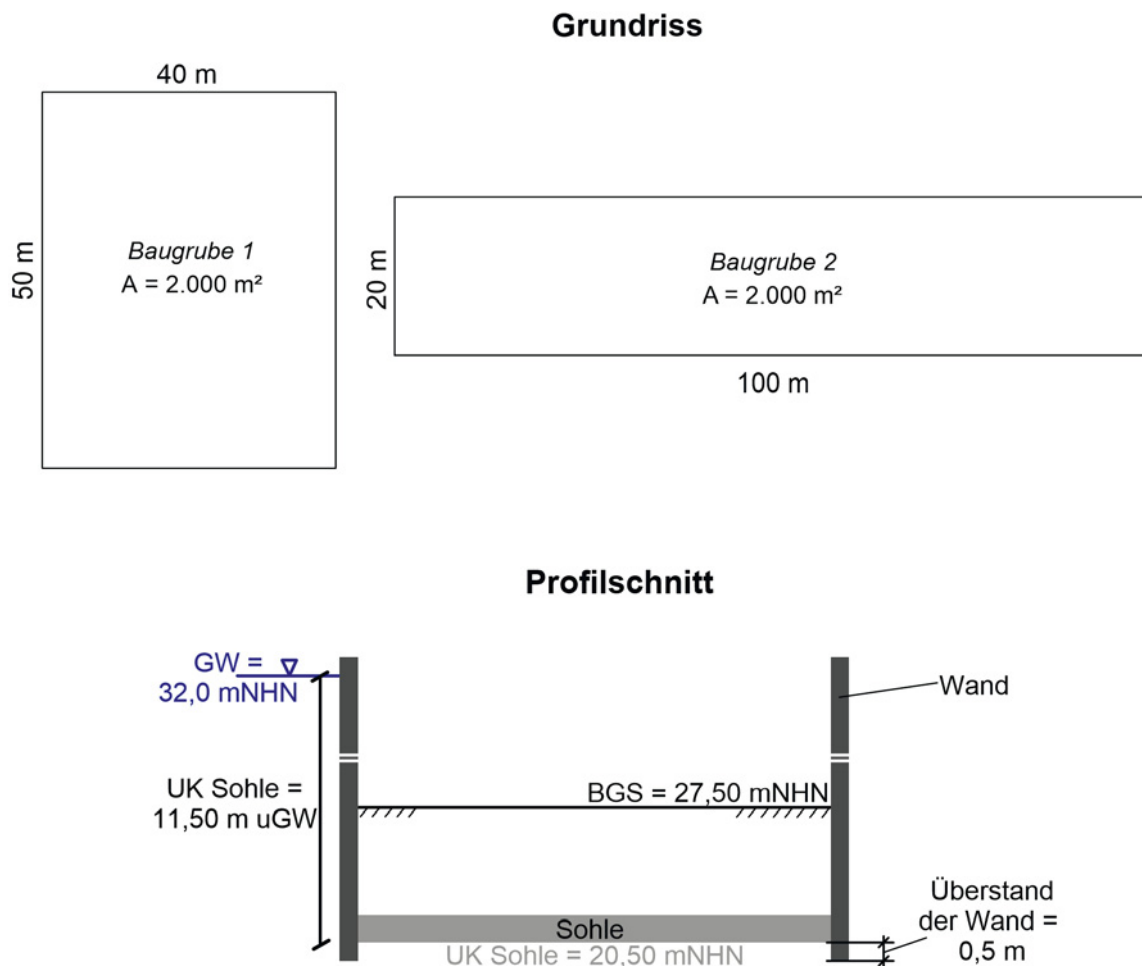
Grundriss und Profilschnitt der Baugruben 1 und 2 (nicht maßstäblich dargestellt)
